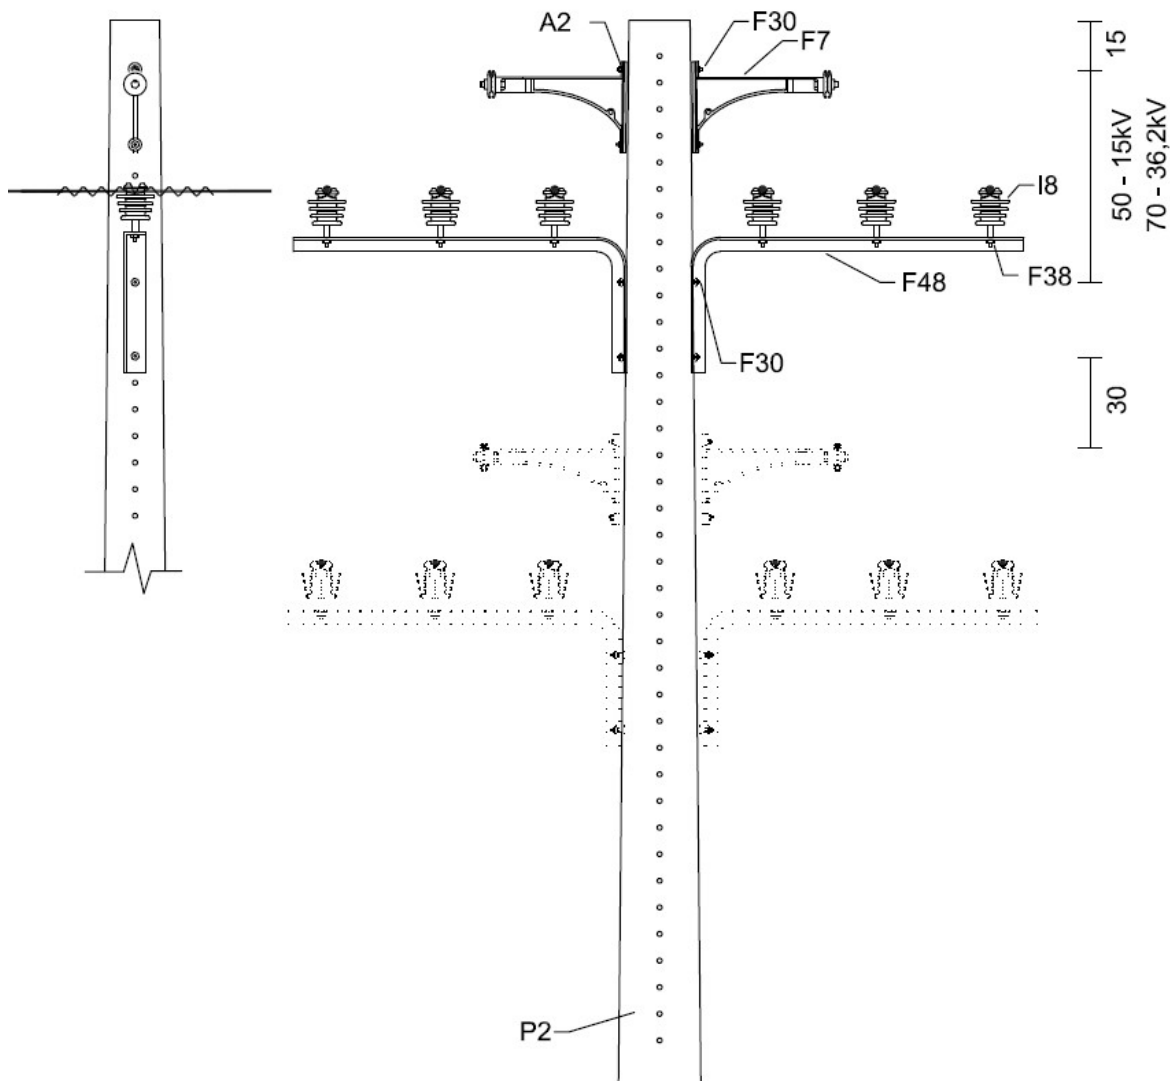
Estrutura CE2H.CE2H com Suporte Horizontal – Poste de Concreto de Seção DT
